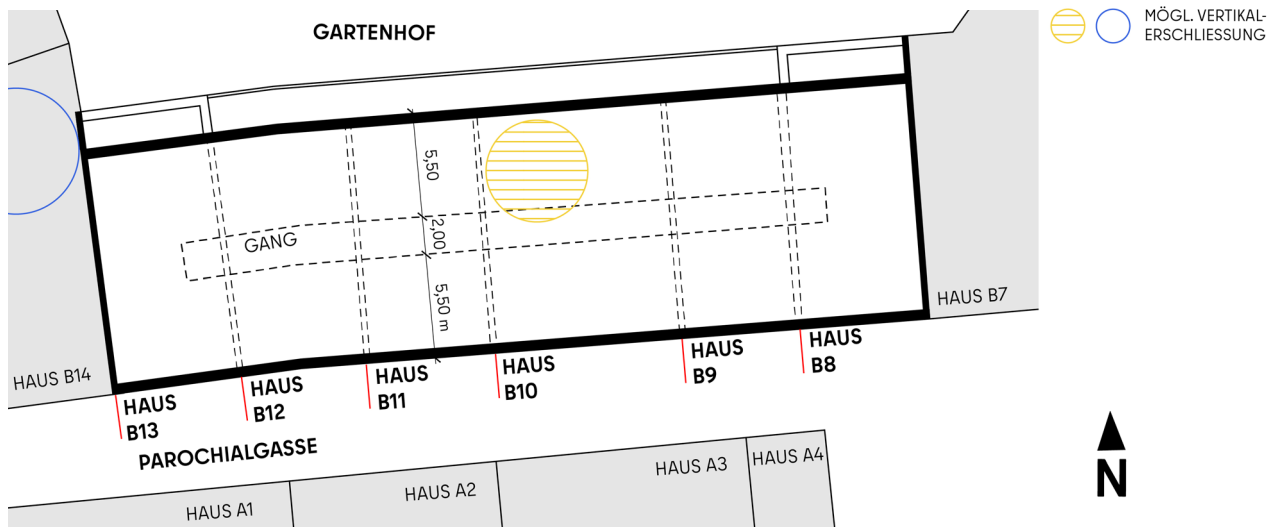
Schematischer Grundriss 3. Obergeschoss als Regelgeschoss
